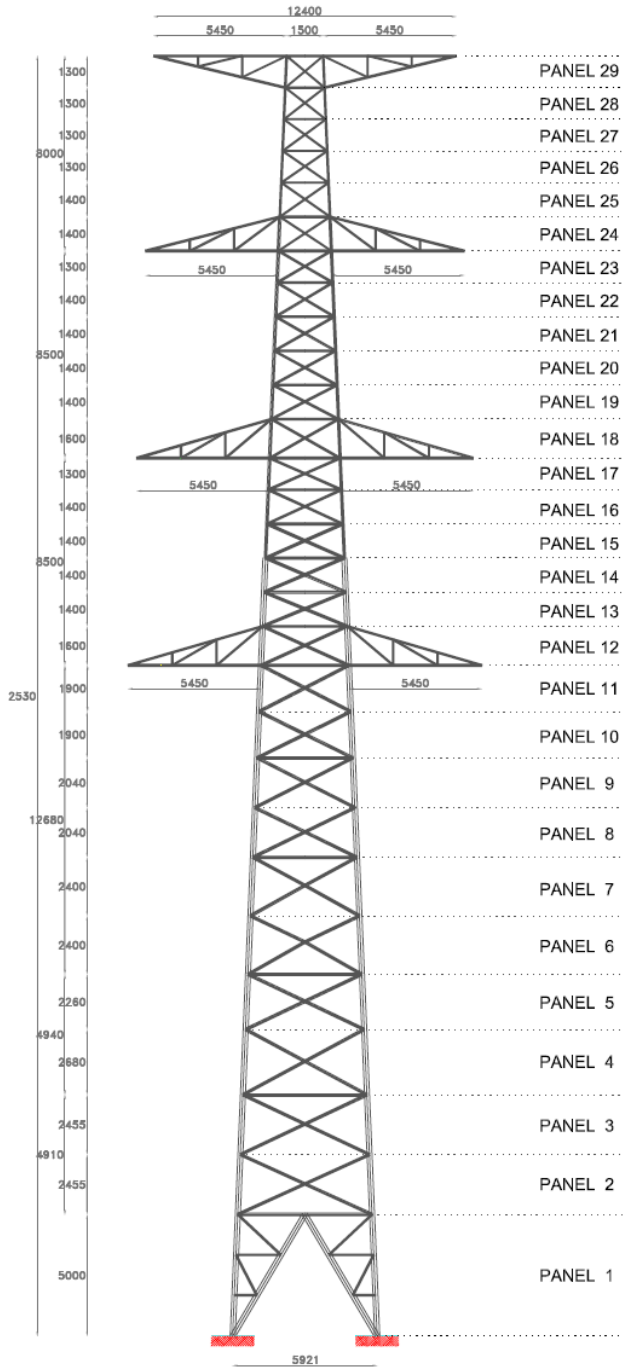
4 Distribución de paneles para el cálculo de fuerzas debidas al viento.
